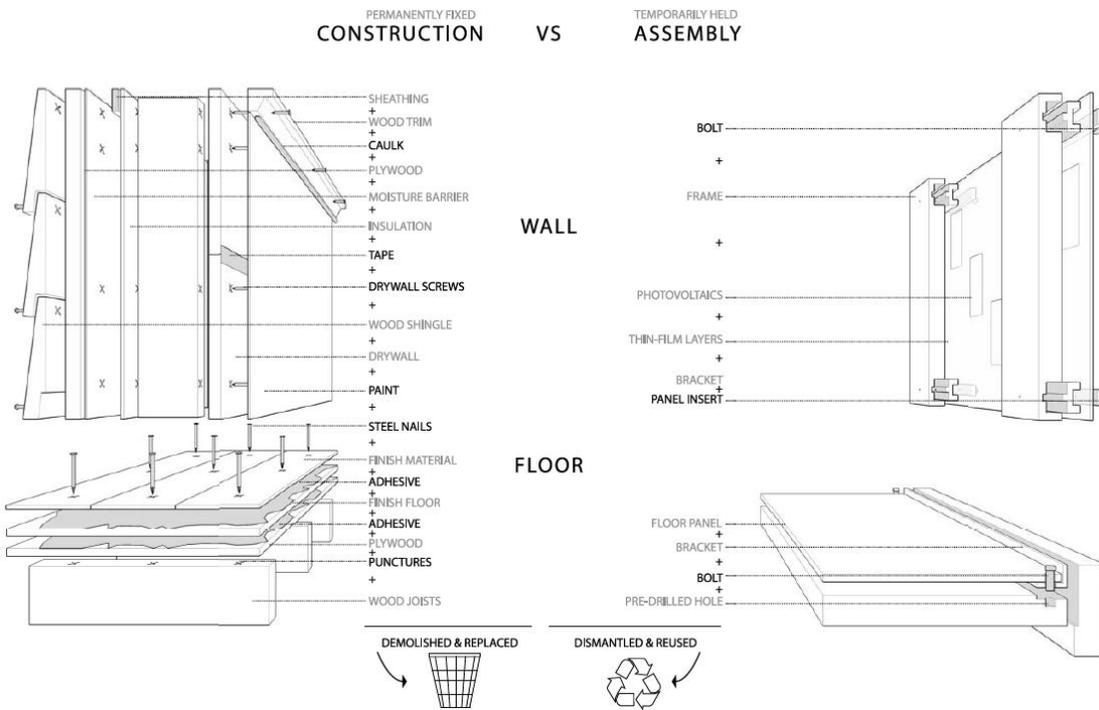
Relación entre construcción tradicional y ensamblaje (Kieran & Timberlake, 2011)
